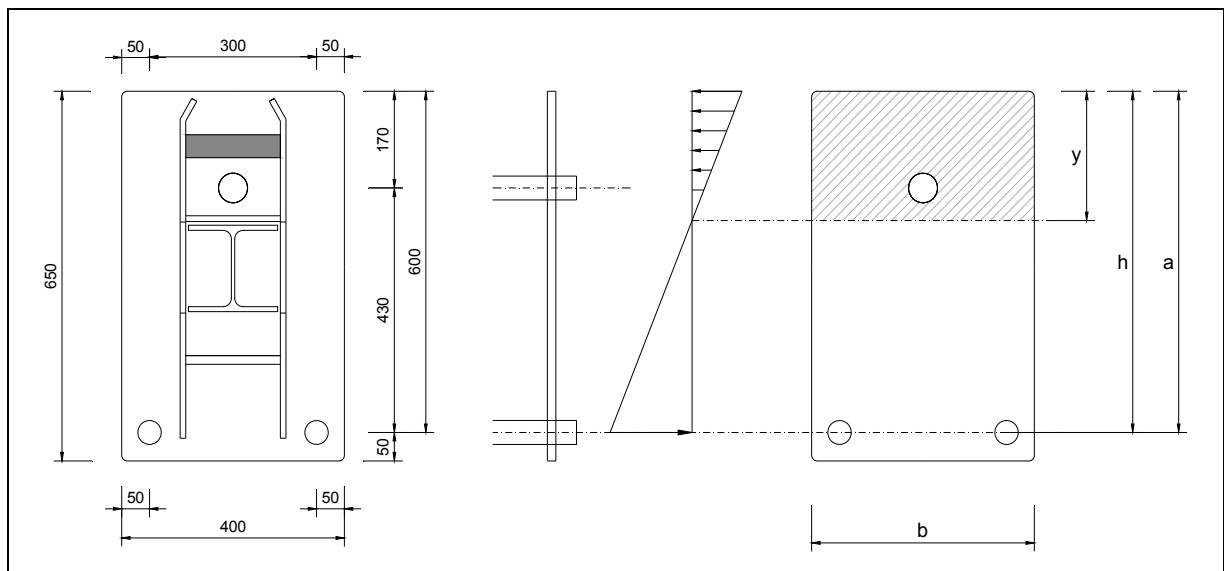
Vista in pianta della piastra di base della barriera RMC 050 ICAT/2 e distribuzione degli sforzi
